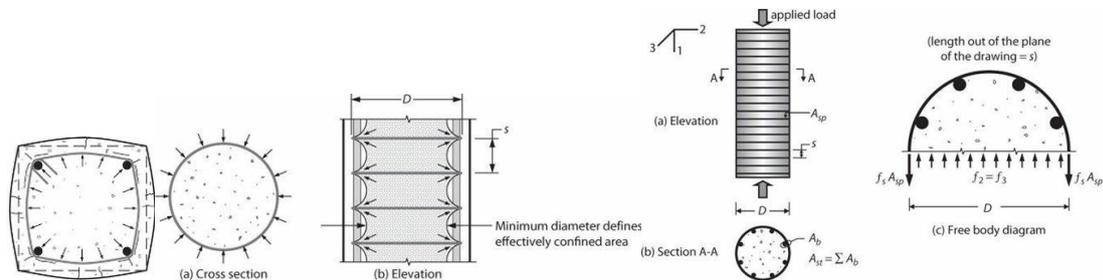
Núcleo de hormigón confinado por estribos. Fuente: Seismic Design of Reinforced Concrete Buildings. J.Mohele. Ed. Mc Graw Hill.
